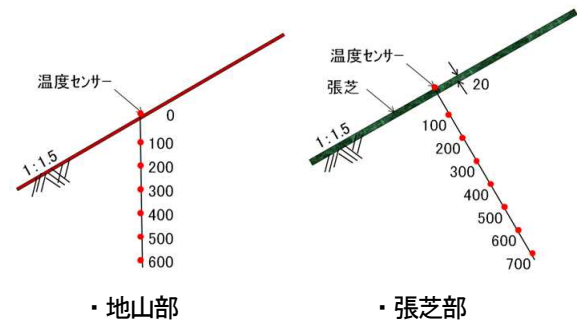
温度を計測した箇所の断面図 (単位: mm)
